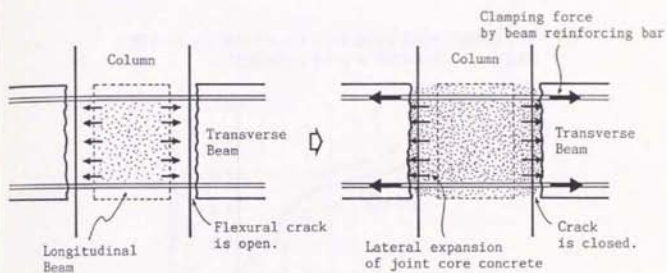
ひびわれのある直交梁が接合部コンクリートを拘束する機構
